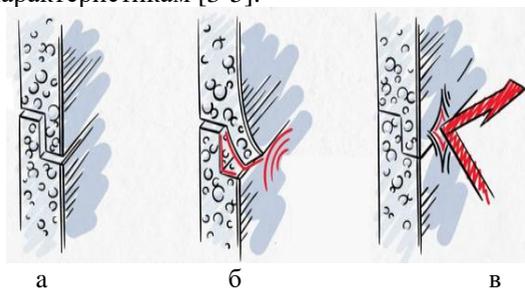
Схема устройства изоляционной оболочки: а – формирование соединения в «замок»; б – сварка отдельных листов пенополиэтилена по шву горячим воздухом; в – бесшовная изоляционная оболочка
